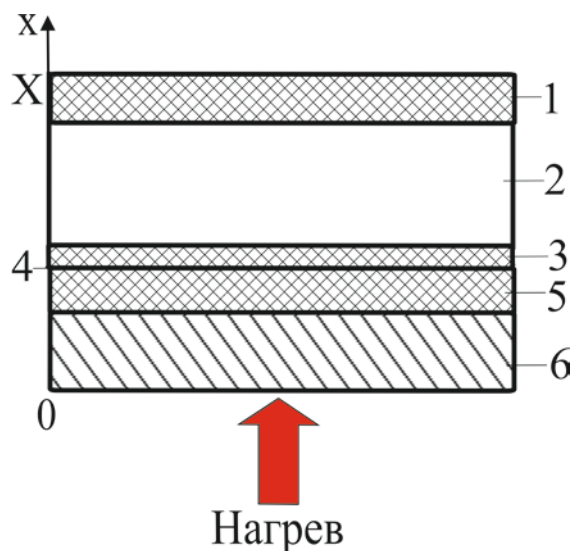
Схема железобетонного перекрытия в одномерной постановке
